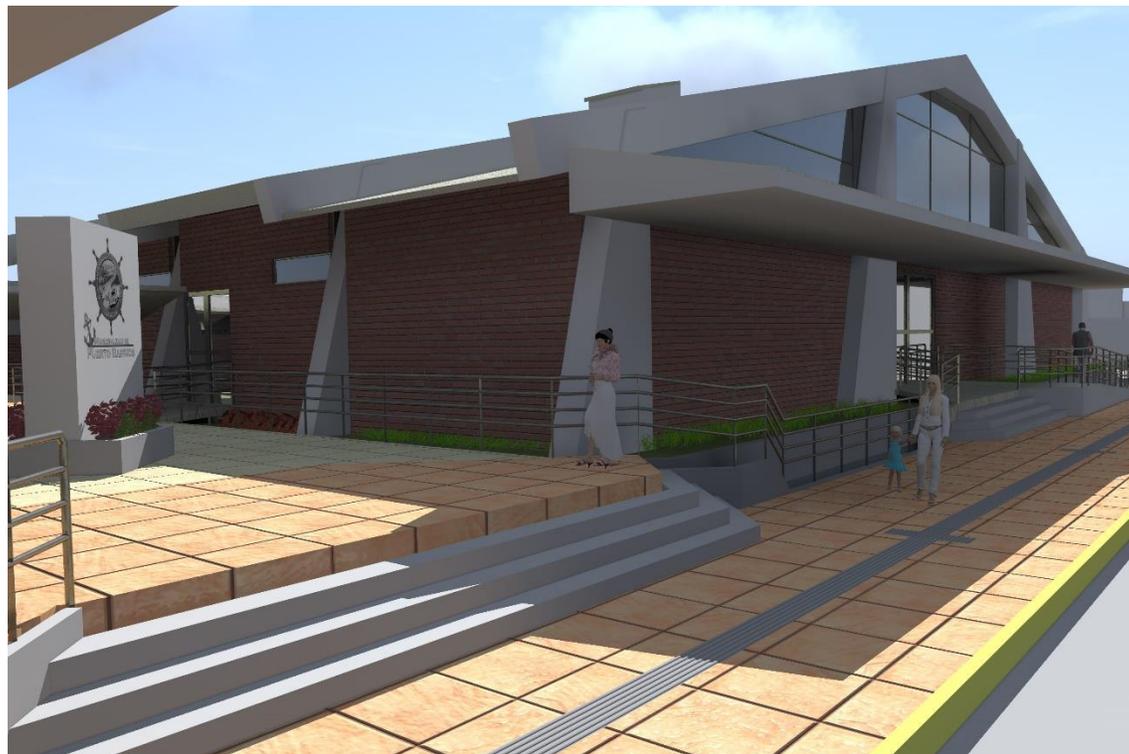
Biblioteca vista desde banqueta sobre 14 avenida.
